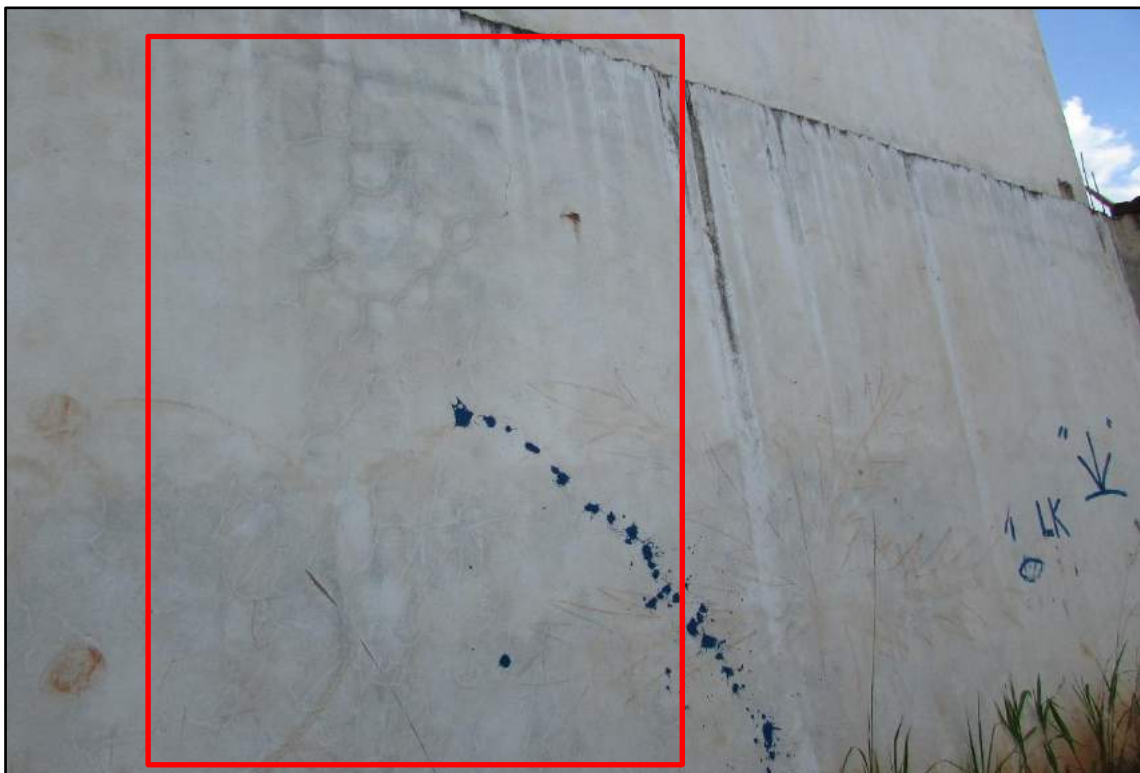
Detalhe do revestimento com a presença de muitas fissuras mapeadas.
